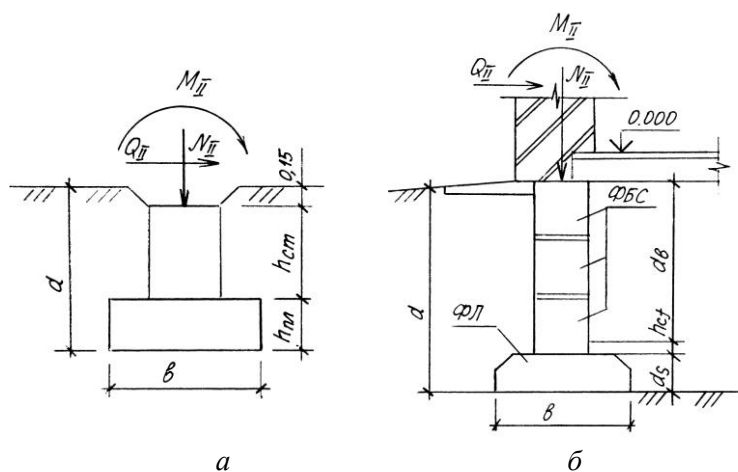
Схемы расчета площади подошвы фундаментов:
